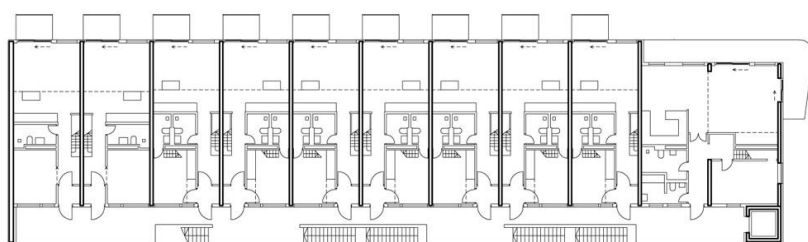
PLANTA DE UM PISO-TIPO DE HOUSING “INNBO”
